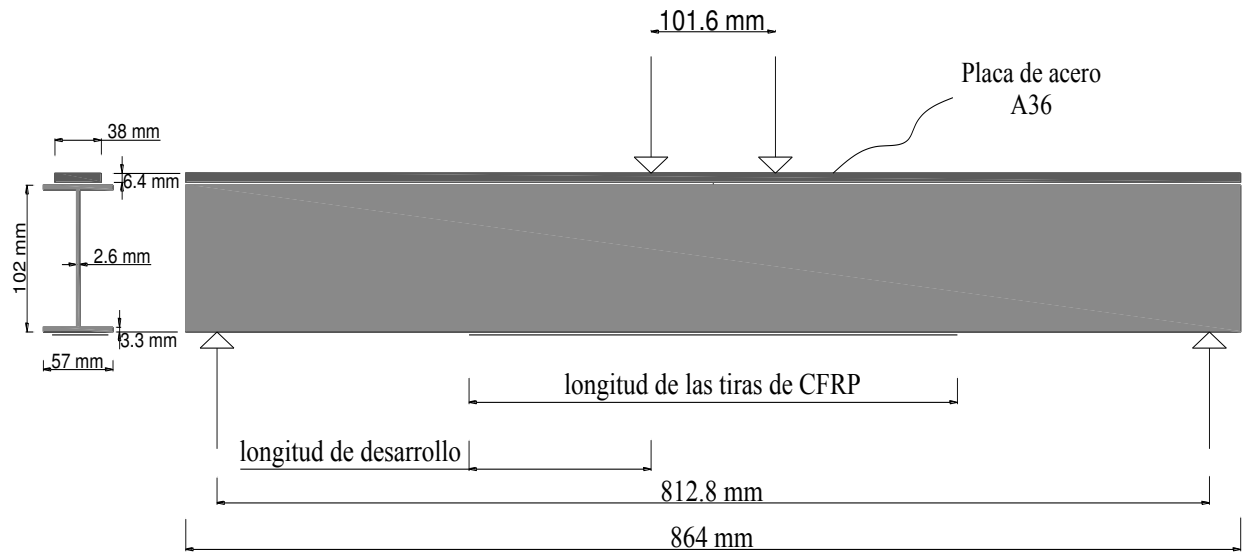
Dimensiones de la sección transversal y configuración de carga de una viga.
